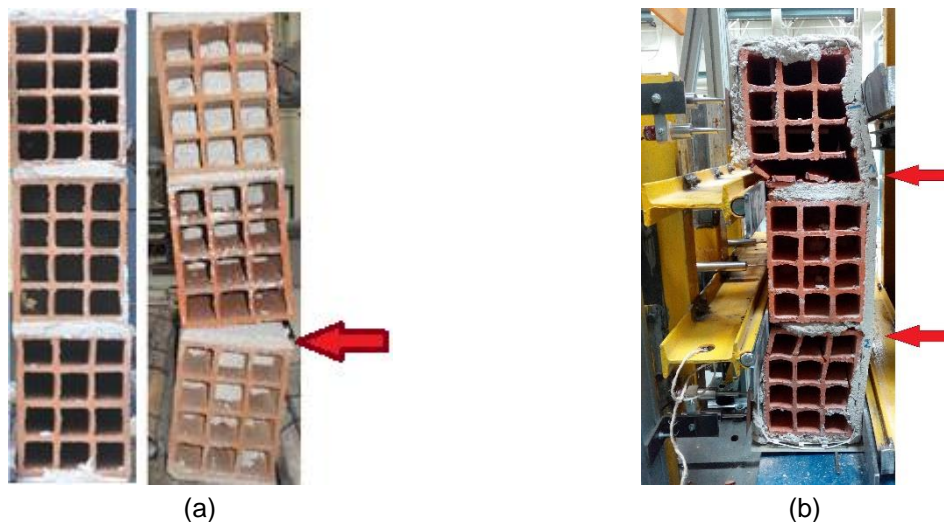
Evolução da fendilhação (a) Murete *NR* (b) Murete reforçado
